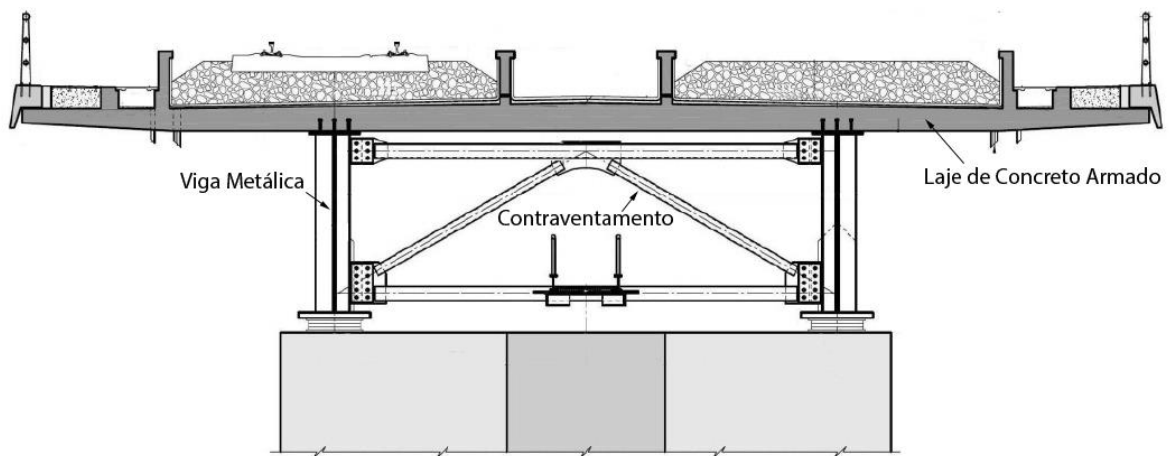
Seção típica do tabuleiro composto por vigas de aço-concreto (Adaptado de Mendes, 2010)
